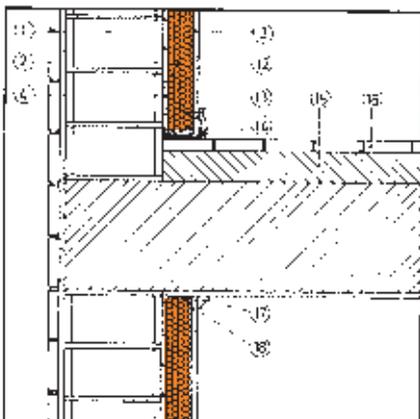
Sezione verticale - Giunti fra controparete e intradosso ed estradosso di solaio
